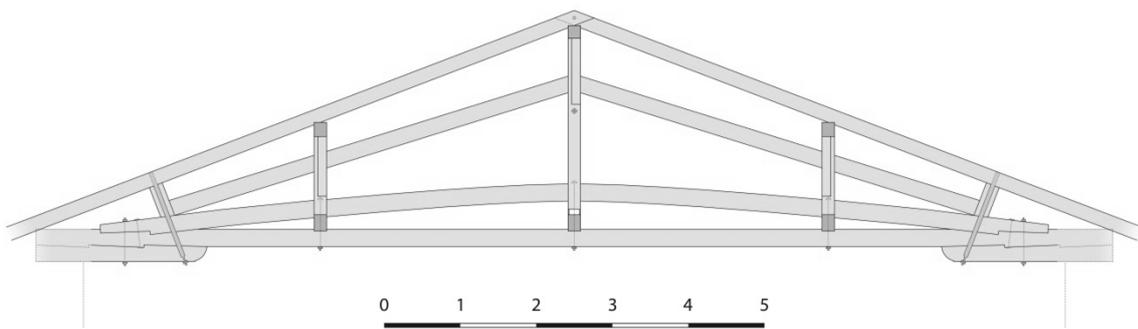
Querschnitt eines Dachwerks des Magazingebäudes der Saline Bad Reichenhalle<sup>15</sup>
